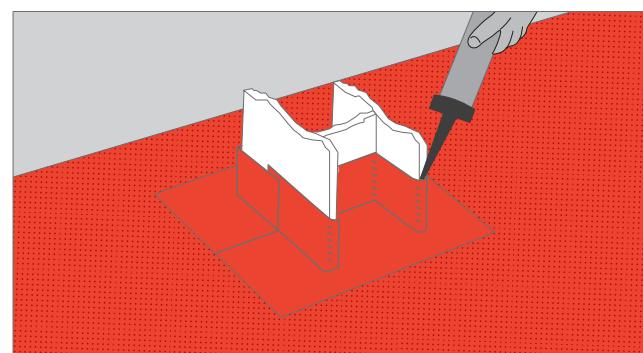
Encuentro de la barrera tipo lámina con un pilar
